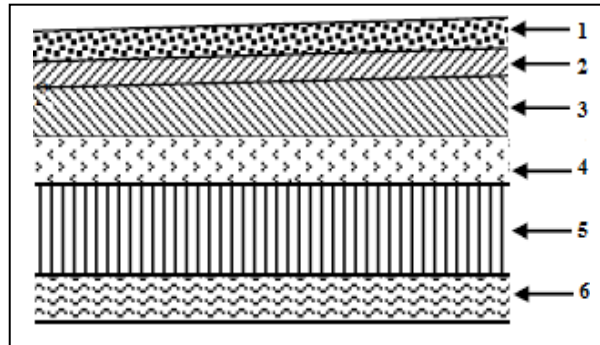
Charges permanentes du plancher T-I à dalle pleine (Ascenseur)
